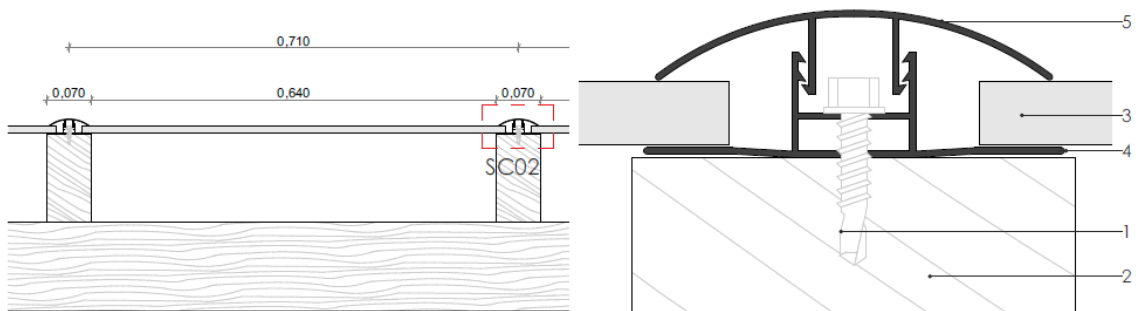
VISTA DE SECCIÓN DE PÉRGOLA. FUENTE: PROPIA
